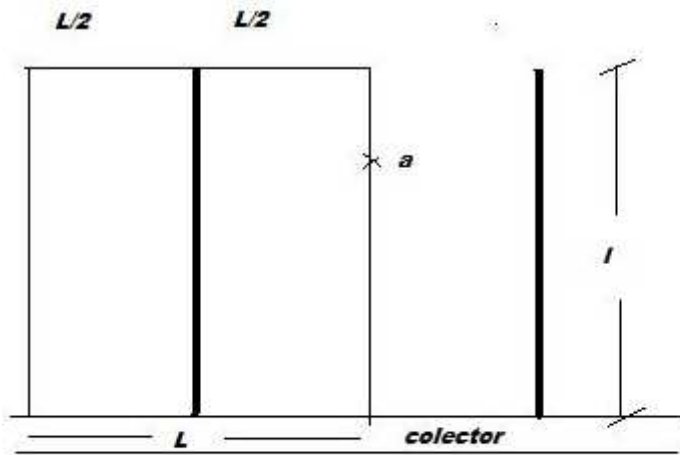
Vista en planta de la superficie de saneamiento y colector.
